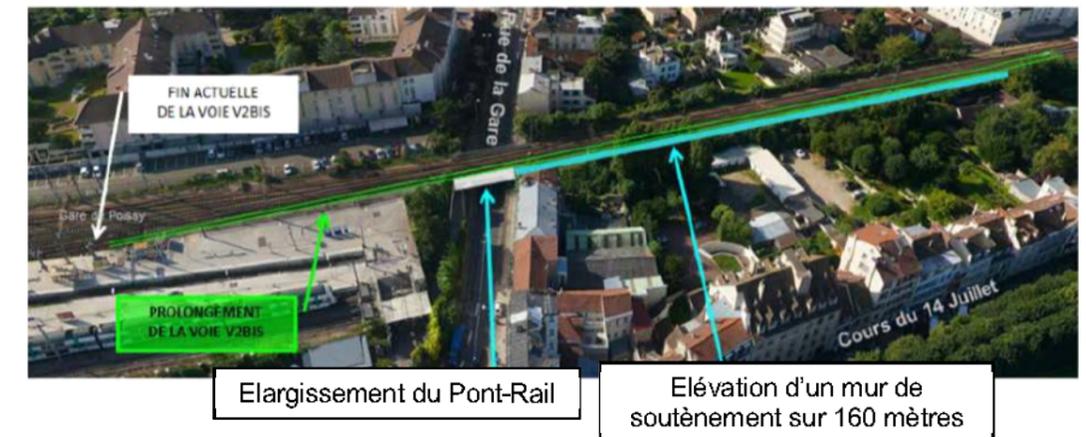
Secteur d'élargissement du pont-rail de la rue de la Gare à Poissy
